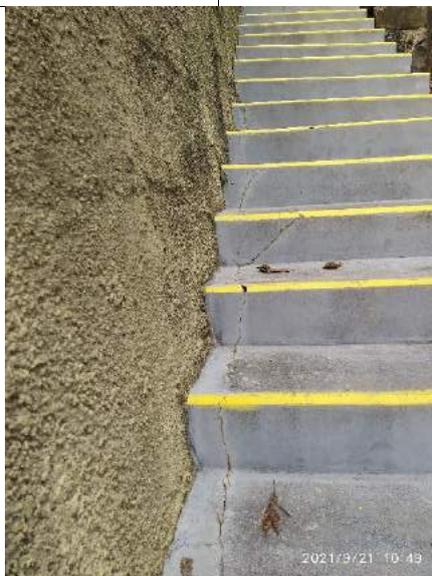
TRINCA NA ESCADA DE ACESSO.
